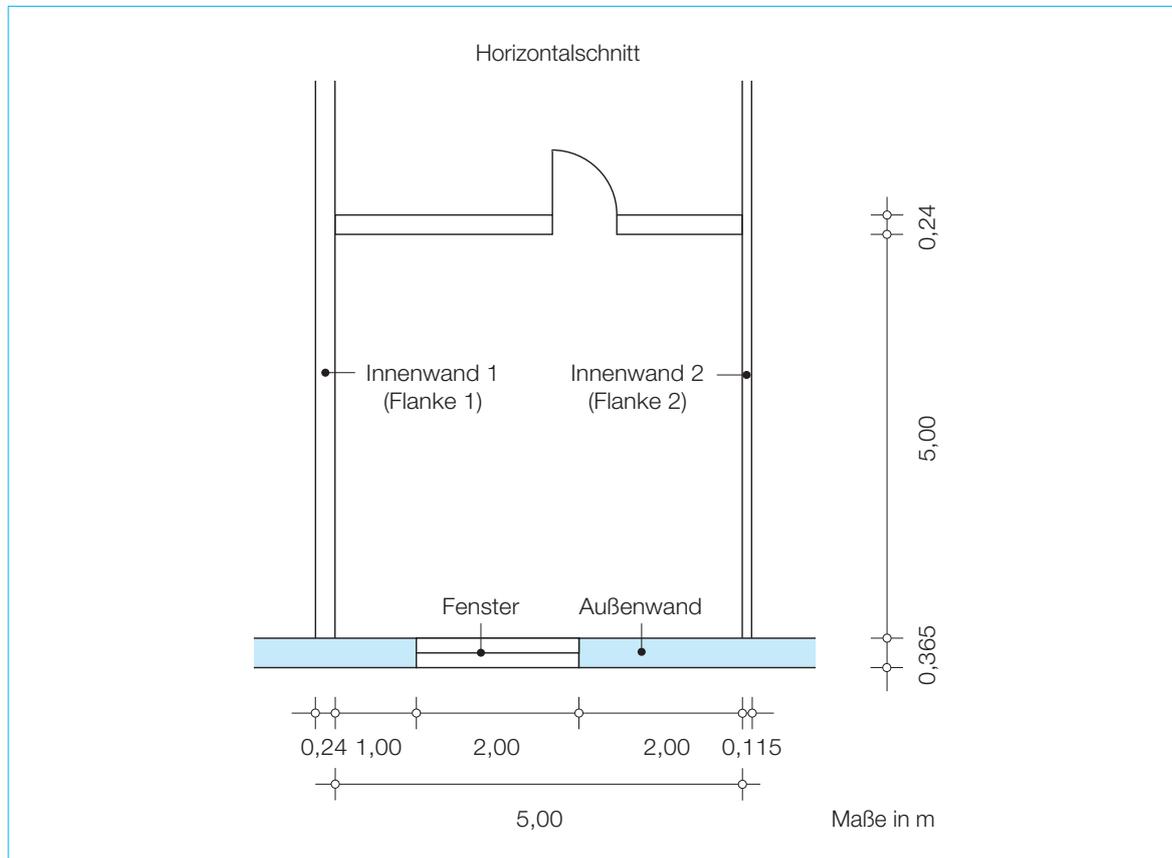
Anschluss einer einschaligen Außenwand aus Porenbetonmauerwerk mit Fenster an einschalige Innenwände aus Kalksandsteinmauerwerk – Darstellung der Raumsituation (Horizontalschnitt) und Bauteilbeschreibung
